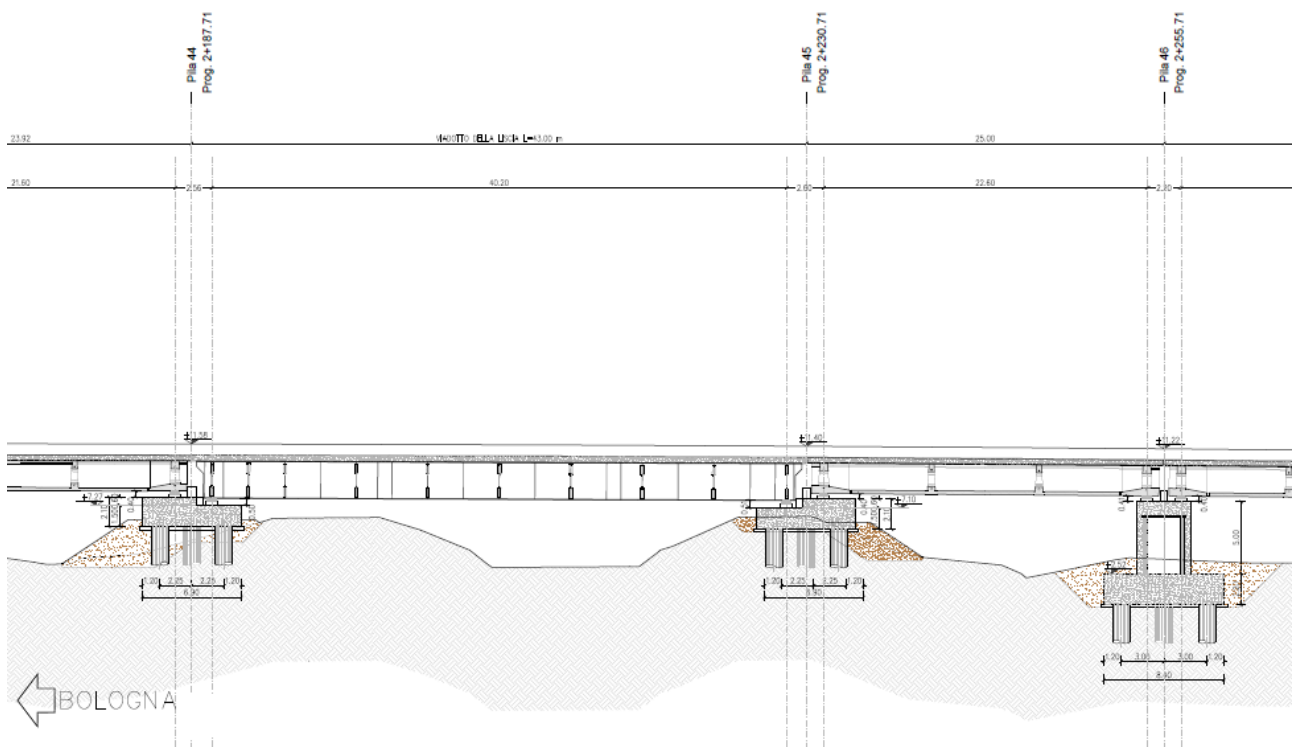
Stralcio della sezione longitudinale limitatamente alle pile P44, P45 e P46 - Progetto esecutivo approvato
